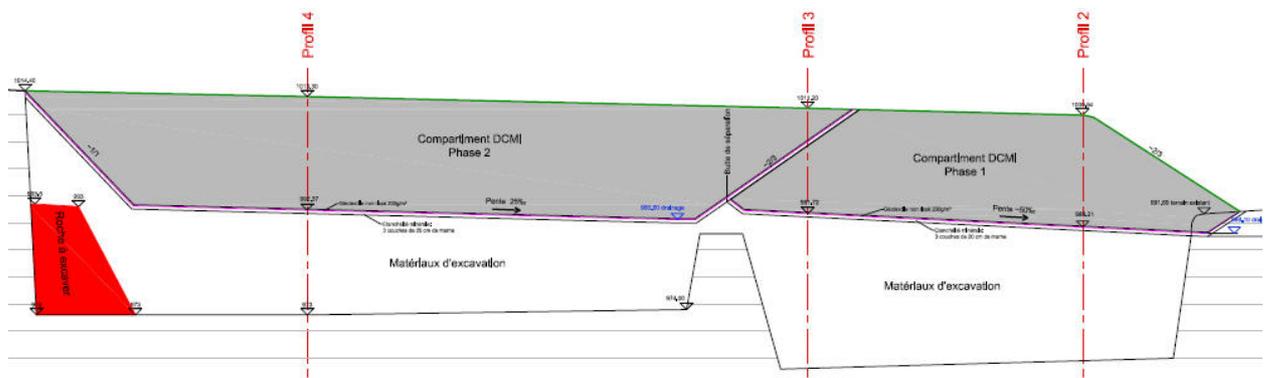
Profil en long Ouest – Est du site de la Fin des Chaux
